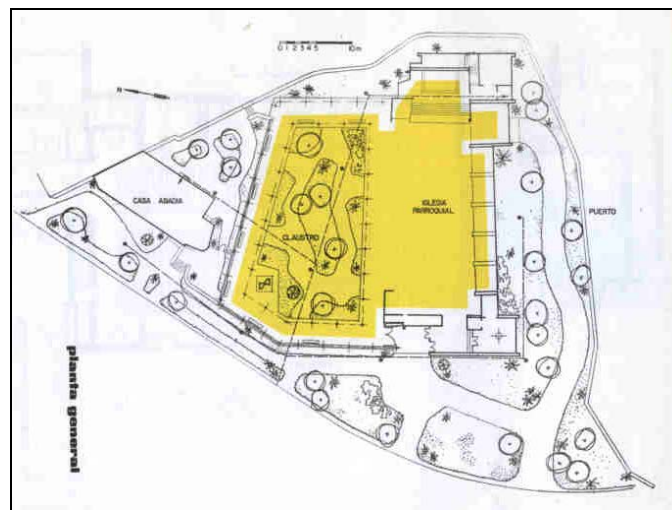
Planta de la ordenación parroquia de San Nicolás
